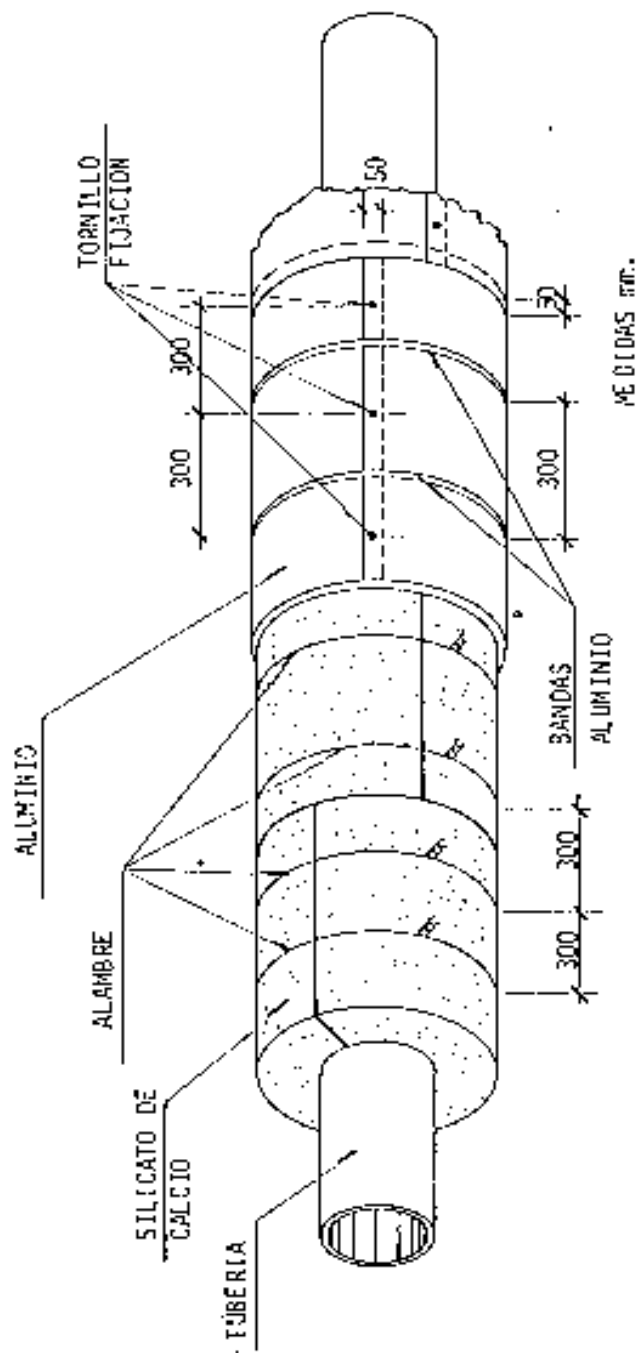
DETALLES INSTALACION AISLAMIENTO TUBERIAS RECTAS
